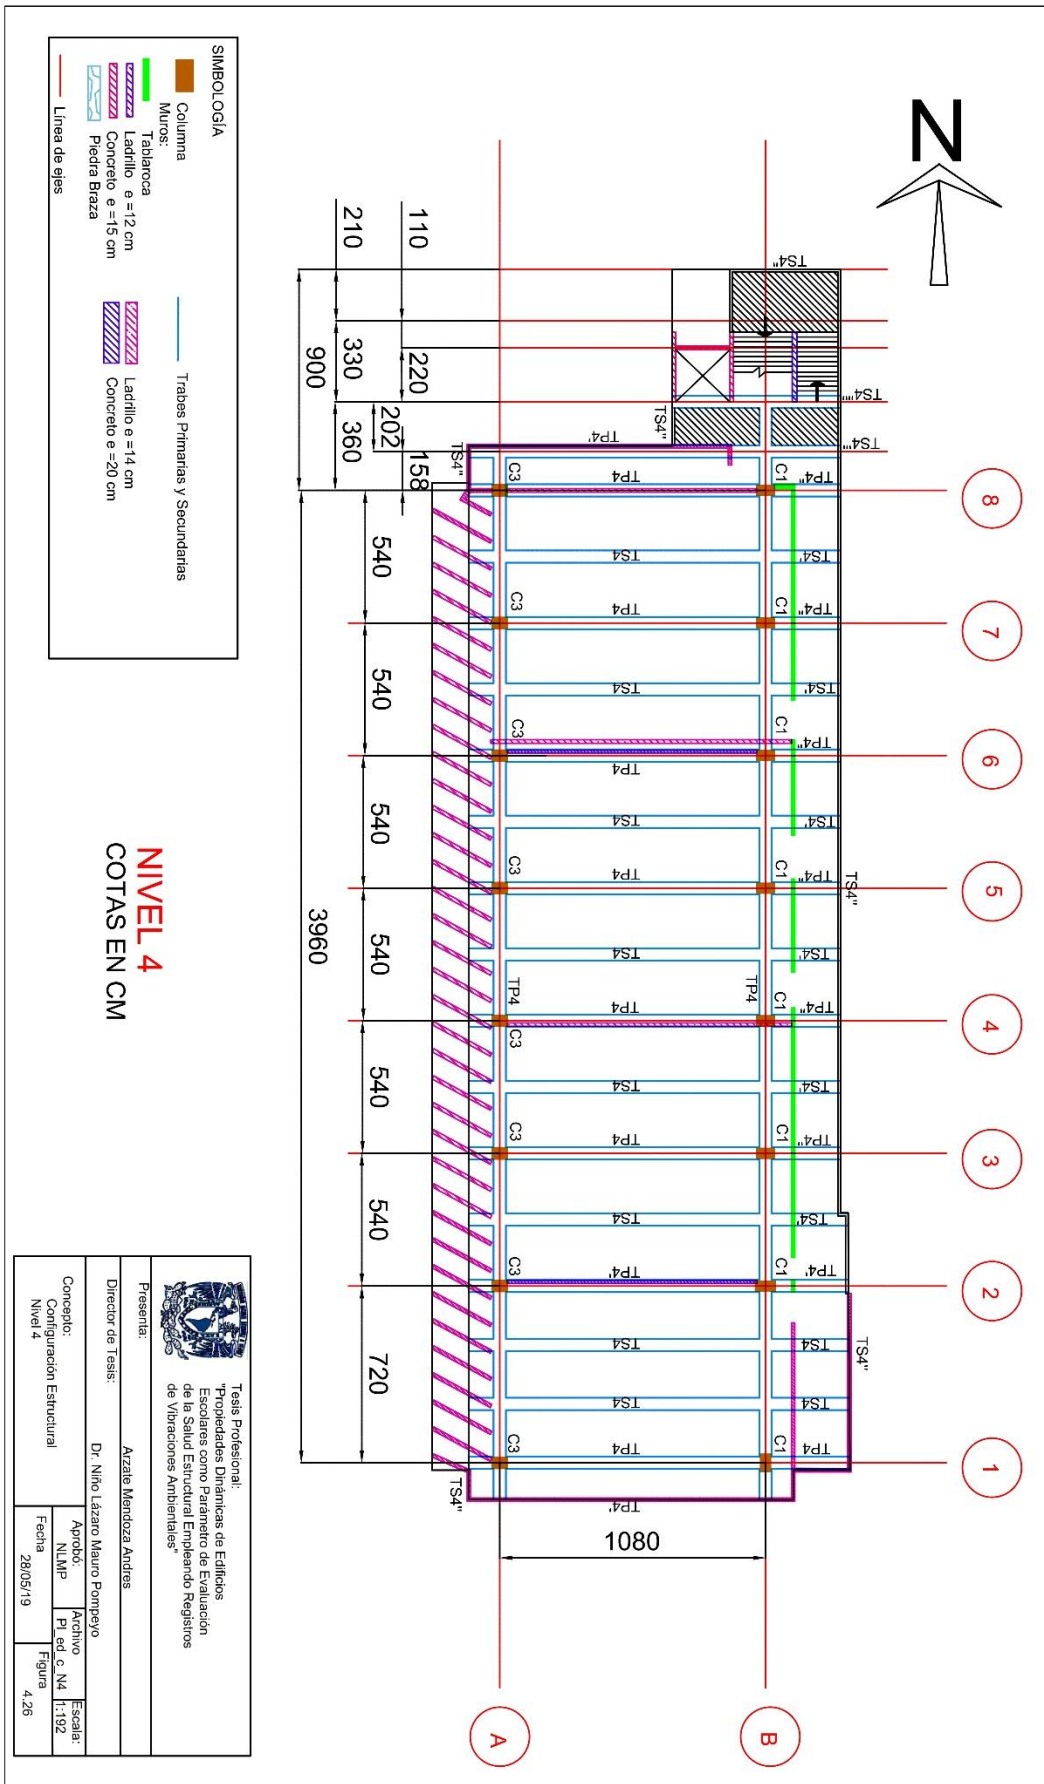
Planta estructural nivel 4 edificio C FI, UNAM
